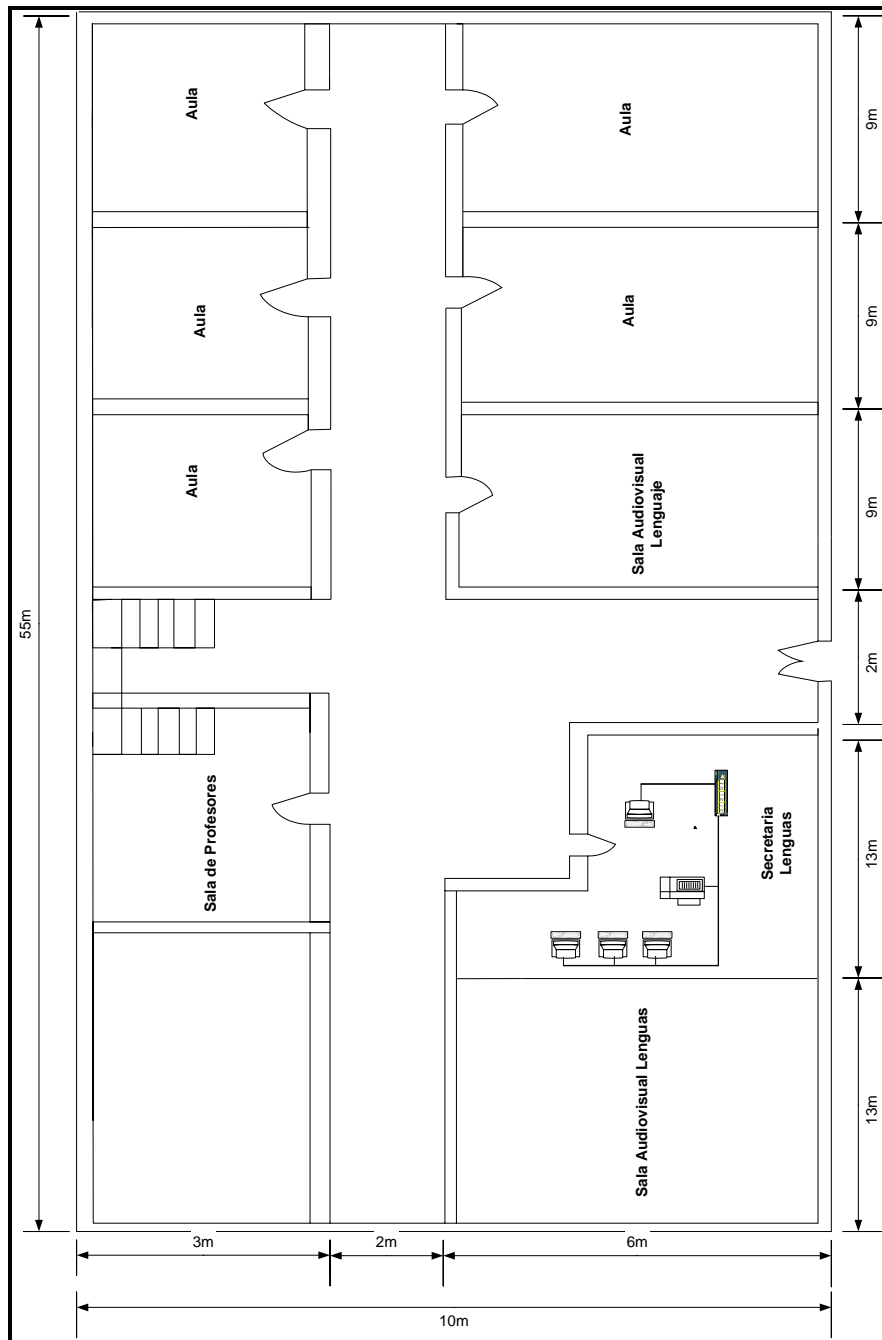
Plano Digital Planta Baja - Edificio Lenguas
